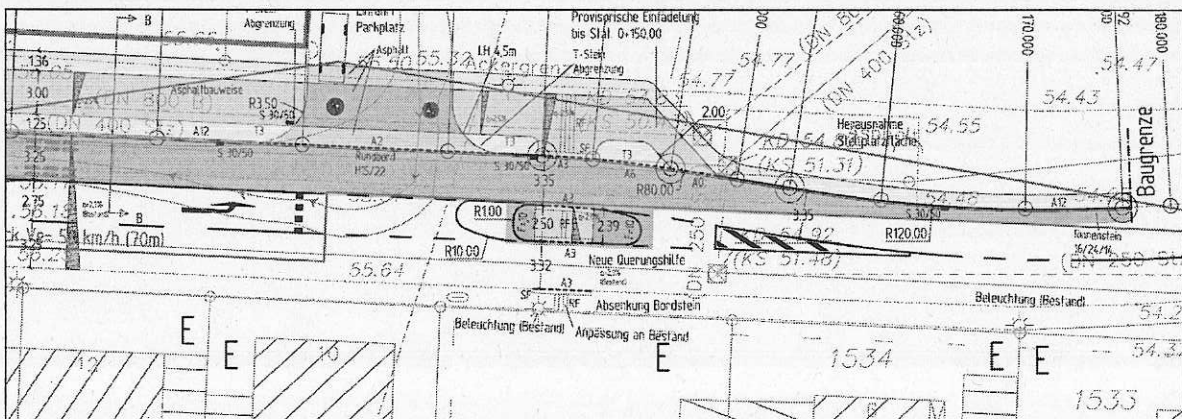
Lageplanausschnitt – Erschließung B-Plan Nr. 306 Johann-Quadt-Straße
